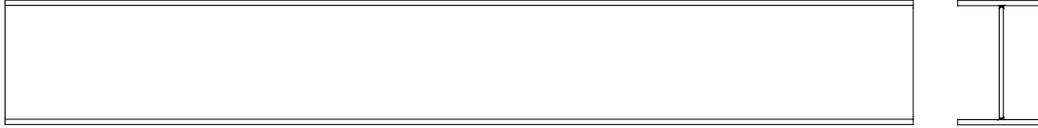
Esquema de las vigas transversales (Véase Planos Anexo VII)
